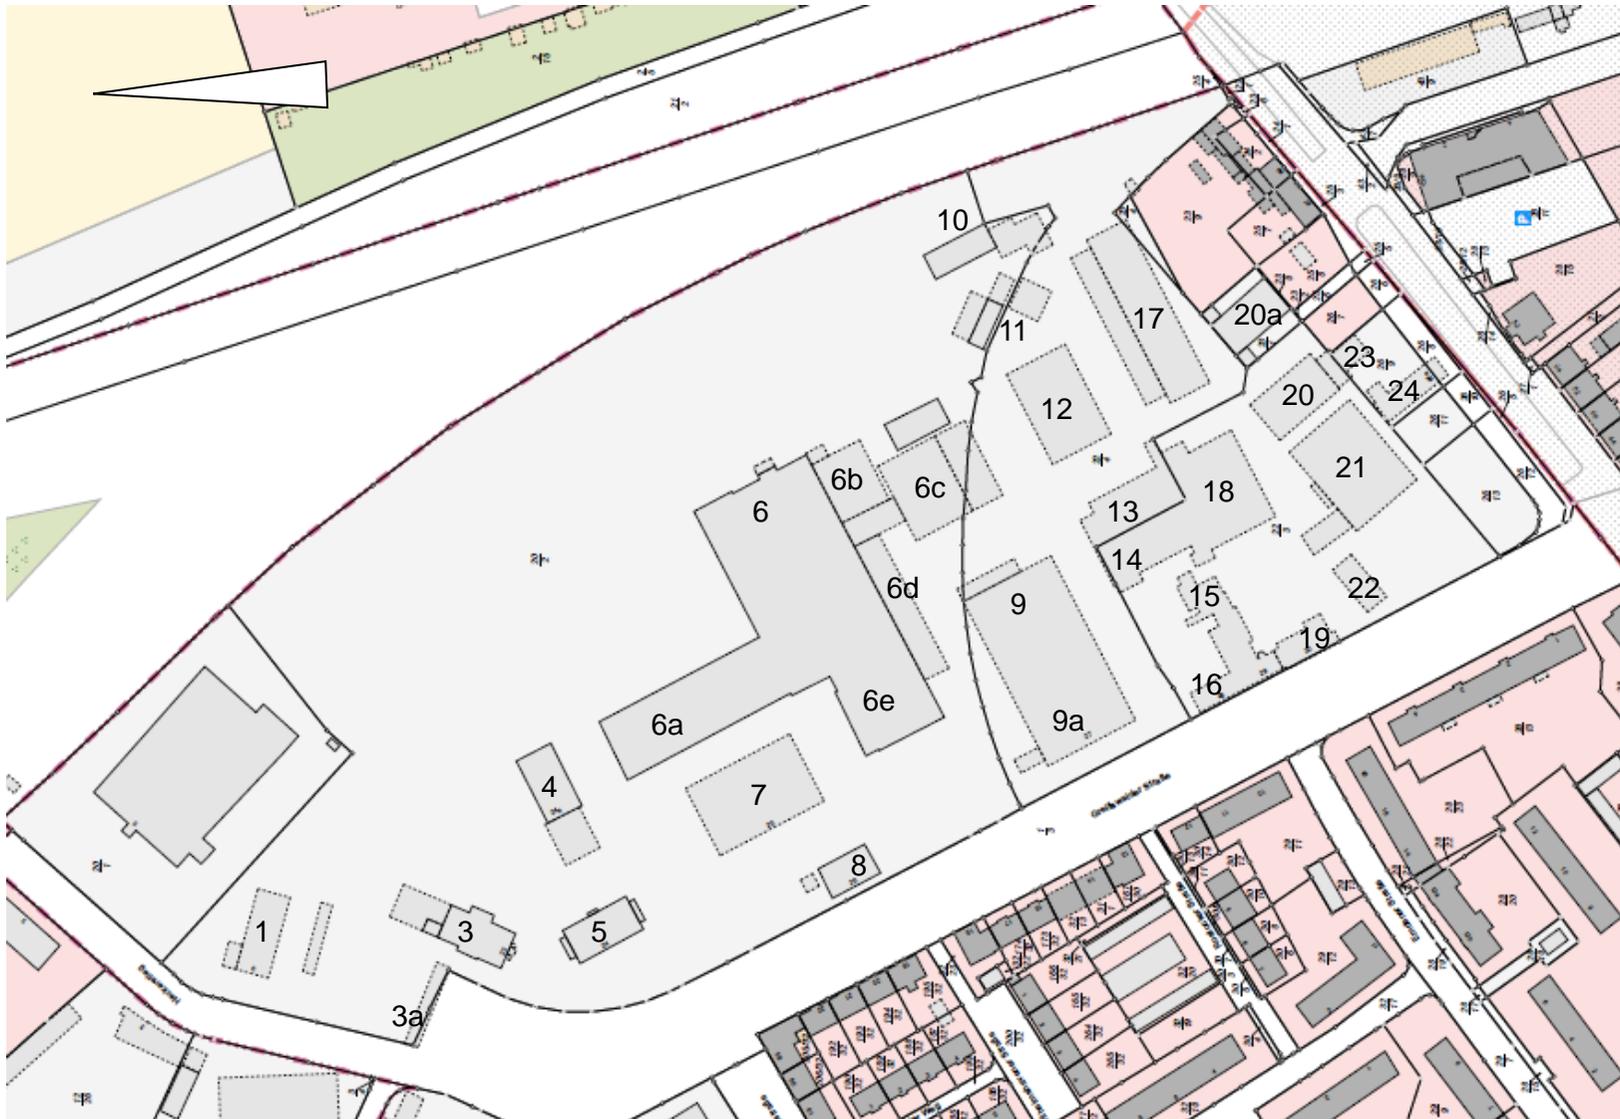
Lageplan mit Markierung der Gebäudekomplexe
